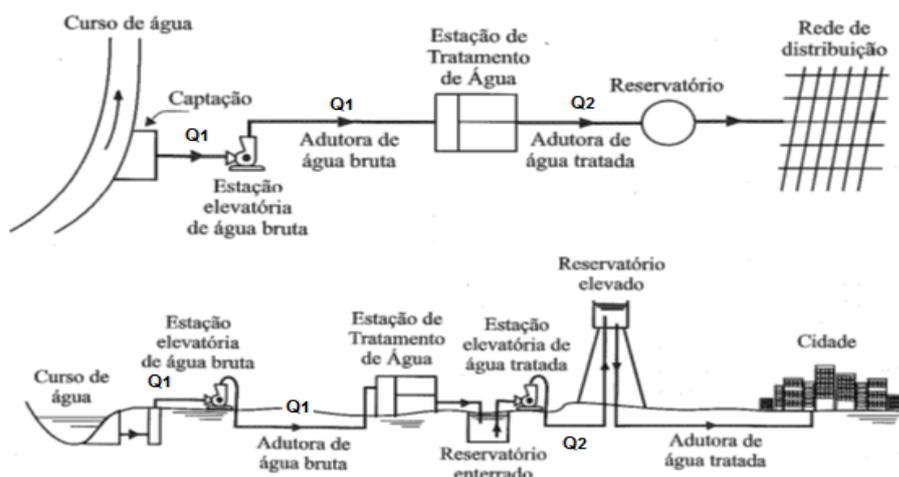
Esquema de adução para terreno plano (TSUTIYA, 2006)
